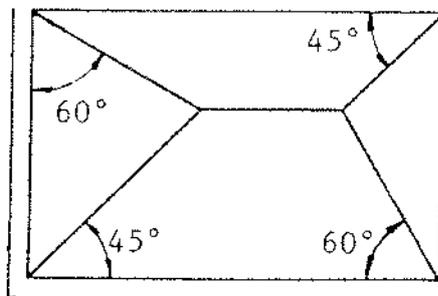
Distribución de la carga para la determinación de las reacciones de apoyo.
